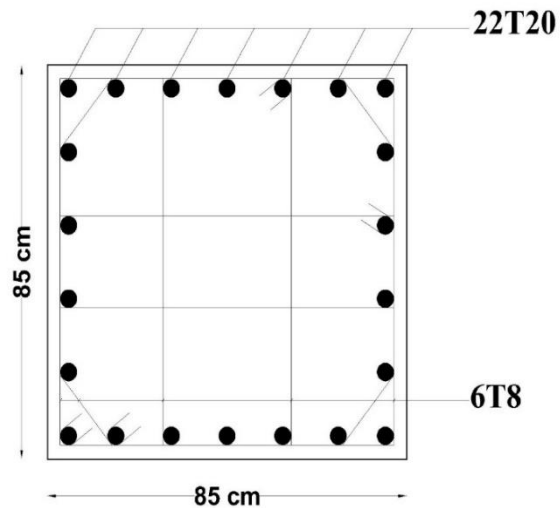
Ferrailage des poteaux des sous-sol (partie 1)
